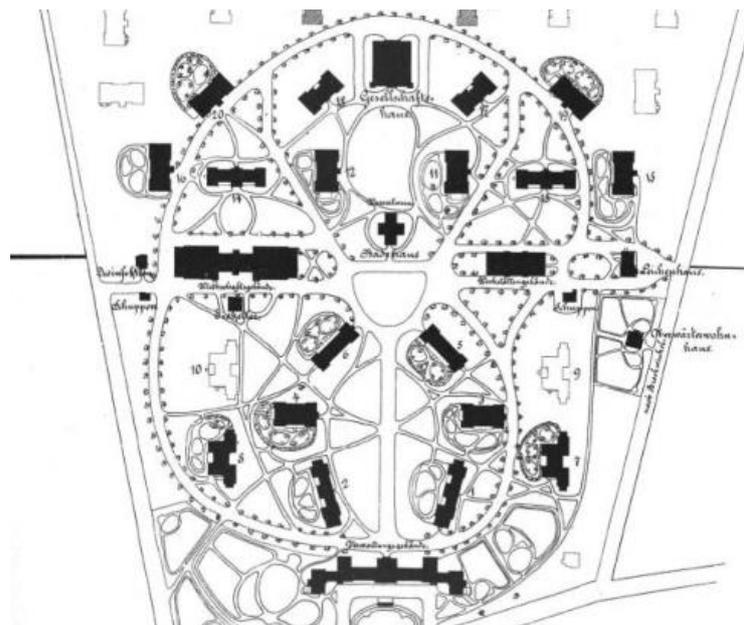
Lageplan der Provinzial- Heil- und Pflegeanstalt Lüneburg, 1901
